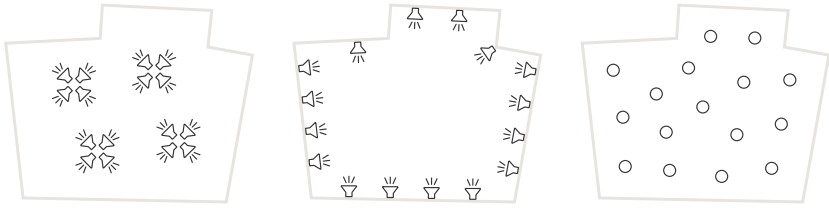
Positionnement en groupes, positionnement mural et installation au plafond de haut-parleurs dans un espace intérieur (vue du dessus).
